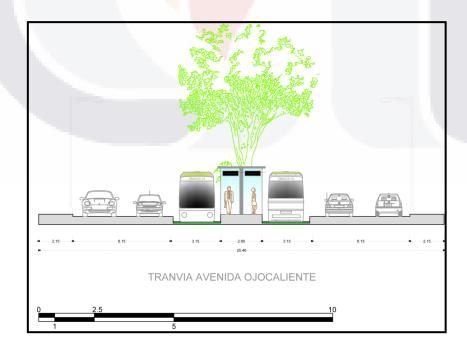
Sección transversal de la propuesta de adecuación de la avenida Ojocaliente
